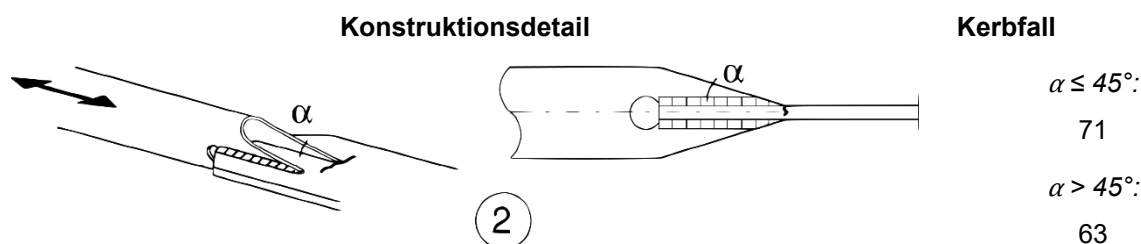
Rohr-Blech-Anschluss, Rohr geschlitzt und an das Blech geschweißt mit Kerbfalleinstufung nach DIN EN 1993-1-9 [1]
